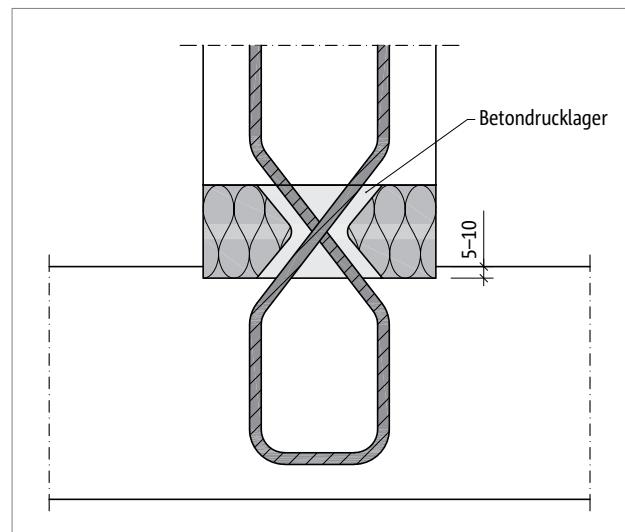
Schöck Sconnex® Typ W: Detail 1; Formschluss durch 5–10 mm tiefe Einsenkung des Dämmkörpers in die Decke
